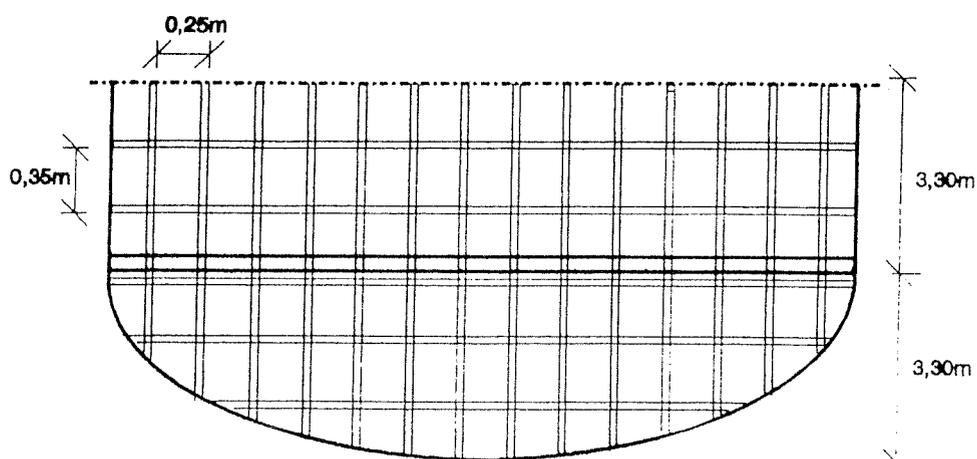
Cavités longitudinales et transversales au dessus de la dalle.
